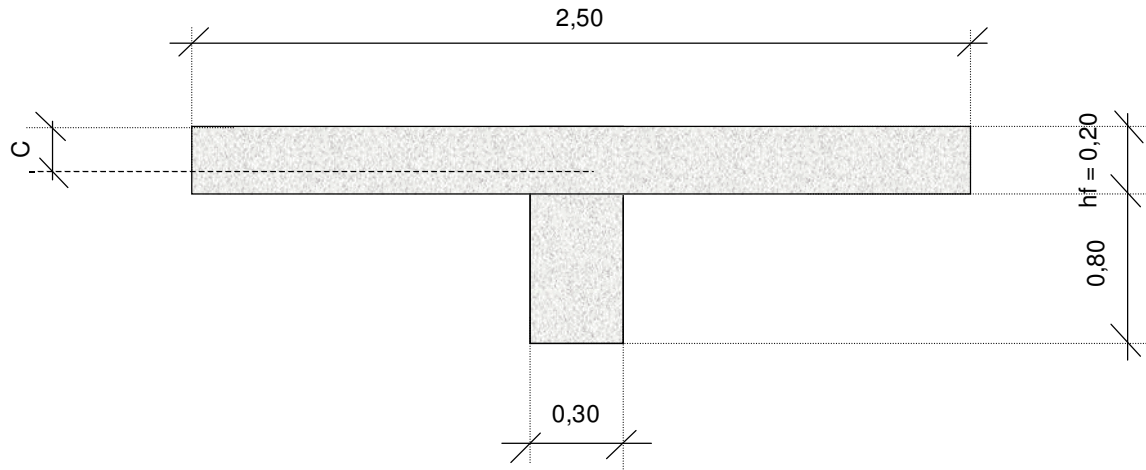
Geometría de la viga prediseñada, tramo central, 3ra. Iteración
